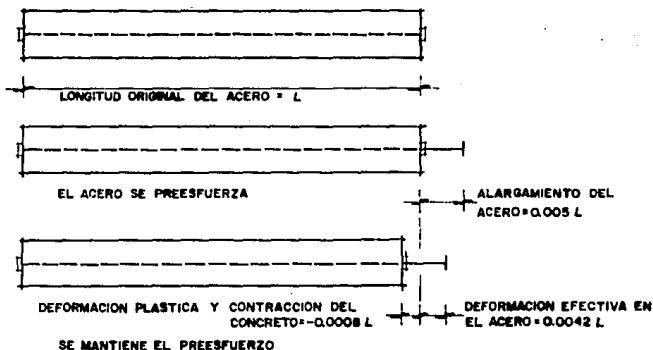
PREESFORZADO DEL CONCRETO CON ACERO DE ALTA RESISTENCIA A LA TENSION.
